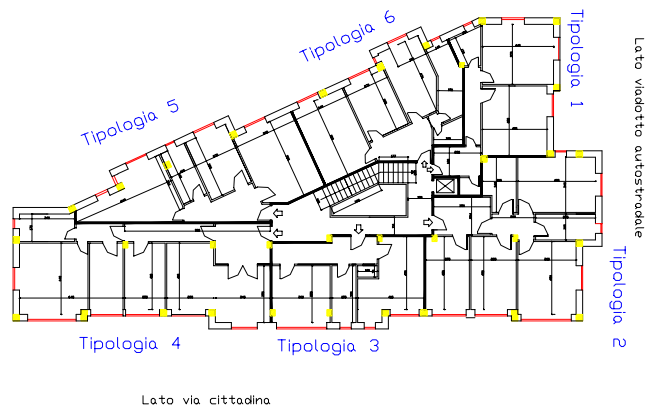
Pianta di un piano-tipo dell'edificio oggetto della sperimentazione.
